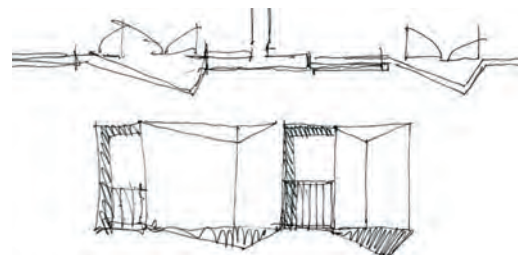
| Schizzo di progetto (dettaglio aperture)
